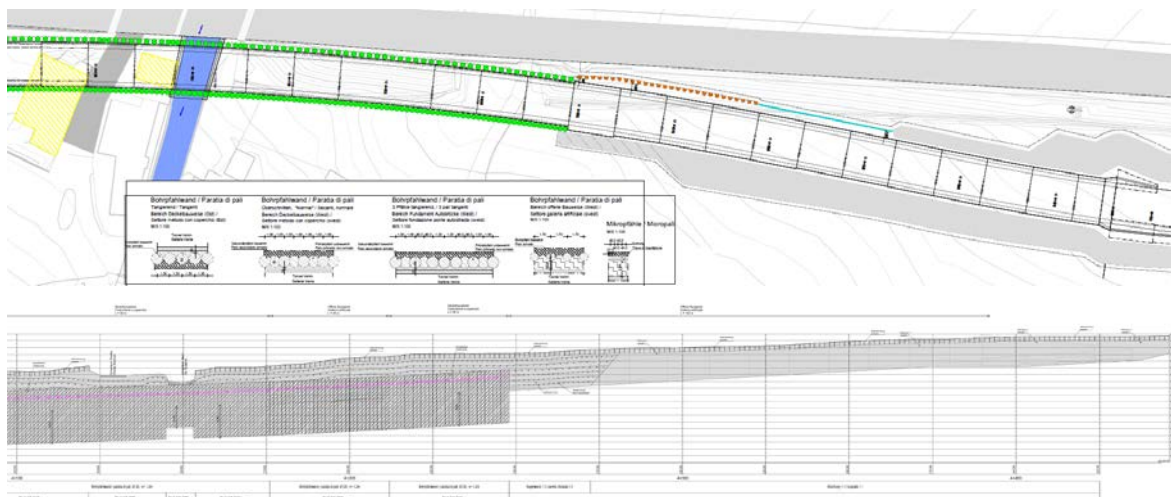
Planimetria e sezione longitudinale Galleria Varna
